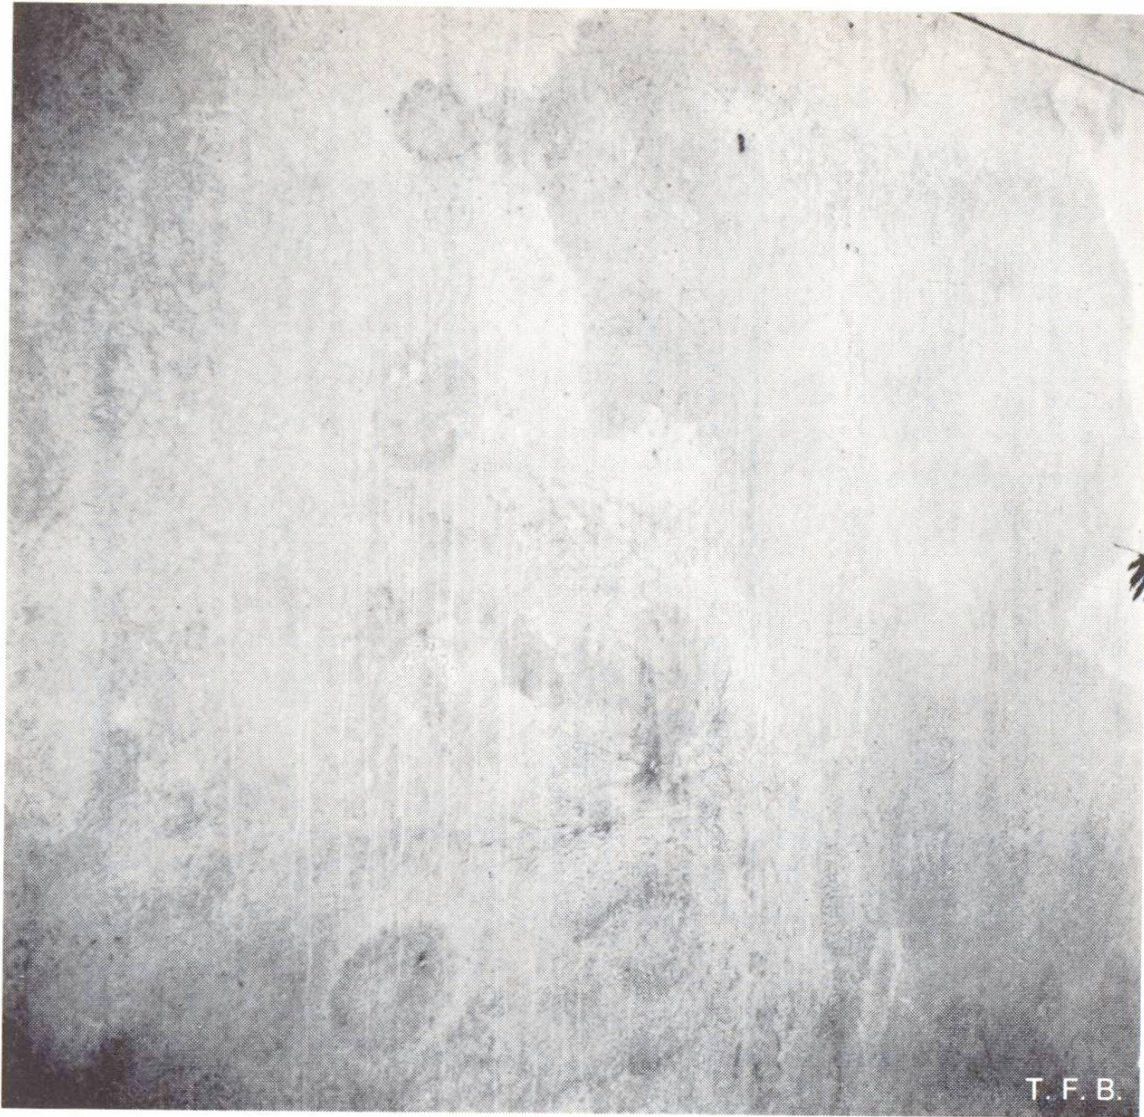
Durch Beton ausgewalztes, pastenförmiges Entschalungsmittel vom Typ C zeichnet sich auf der Betonoberfläche ab.
